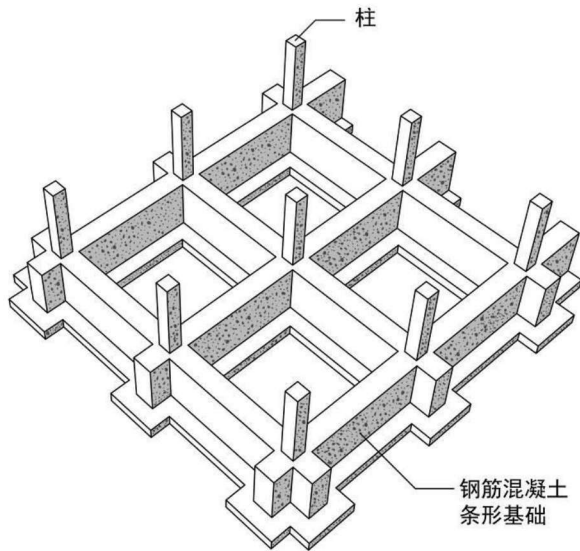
柱下钢筋混凝土条形基础条形基础
